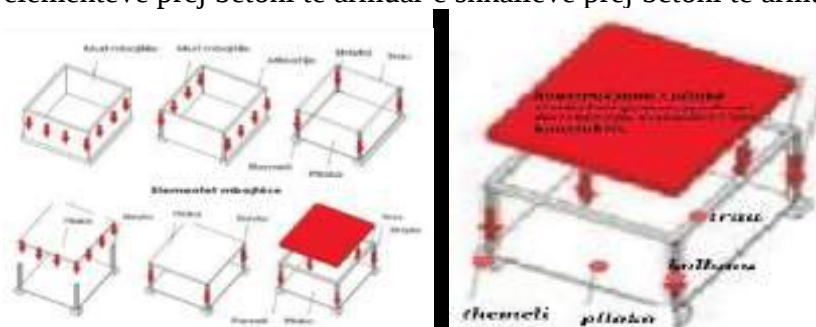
Skema statike e konstruktive e elementet konstruktiv të godinave.
